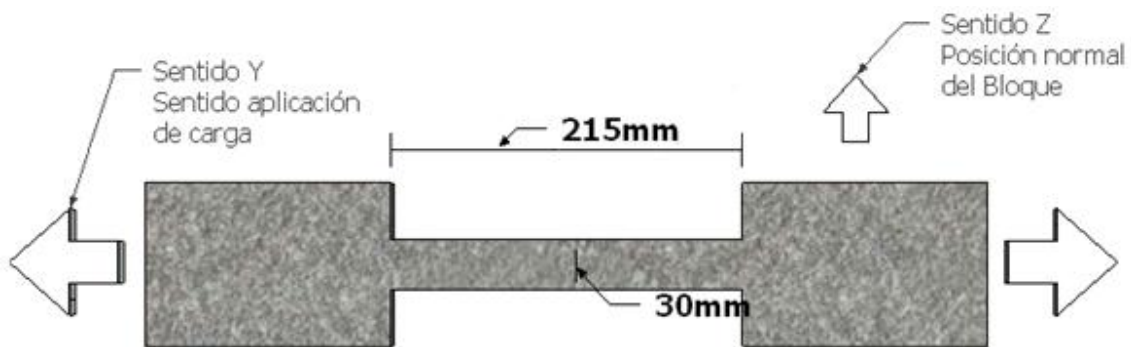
Esquema de muestra tipo probeta ensayo a tensión. Fuente: Autor
